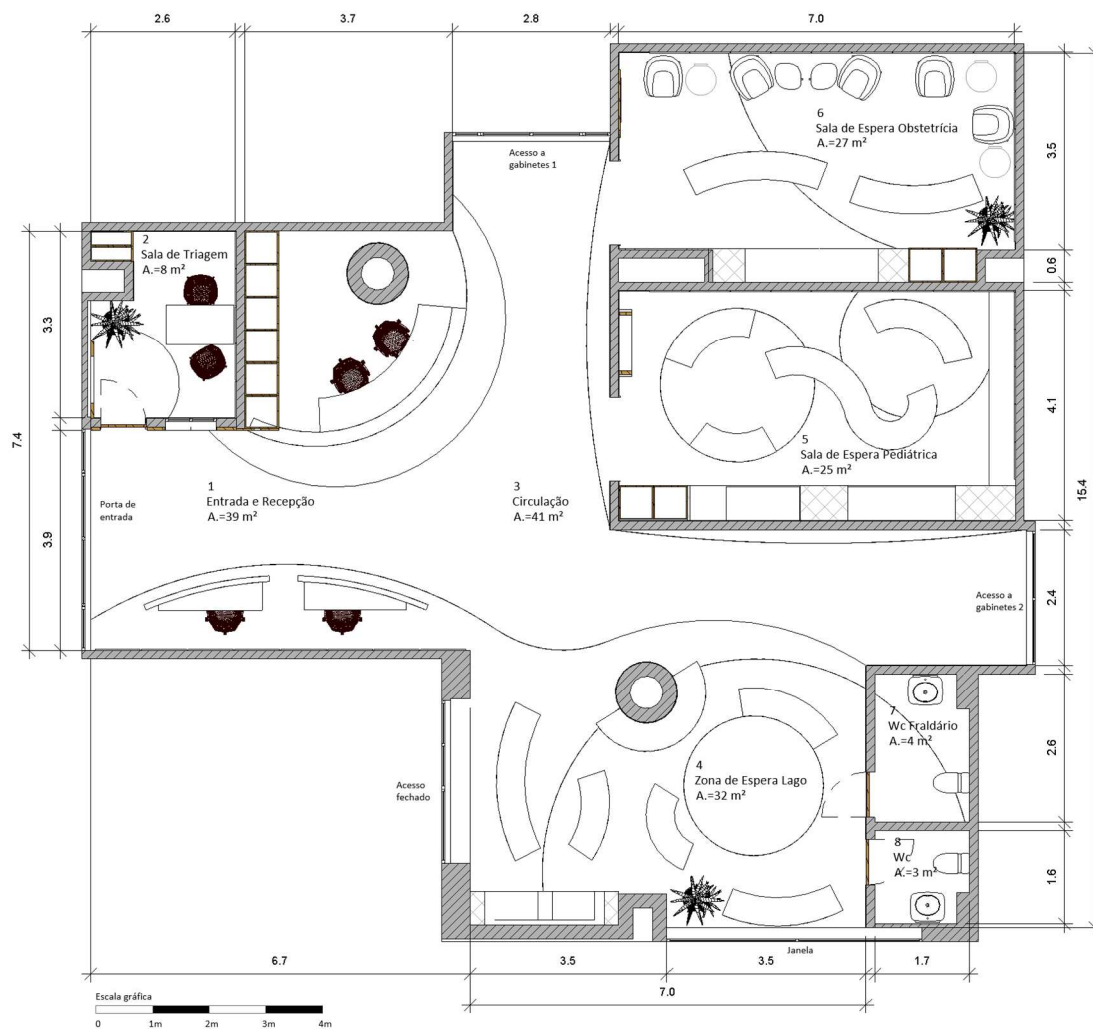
Desenho de projeto, Planta de Arquitetura Proposta. Fonte: Autora.
